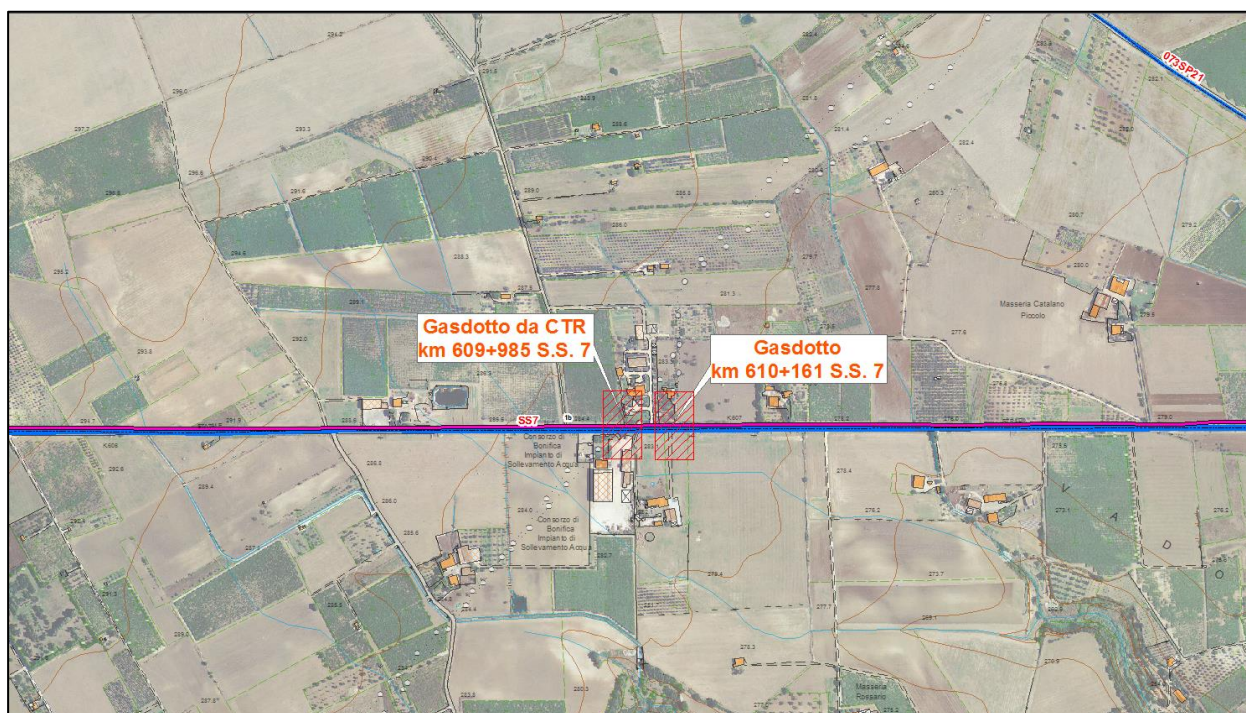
Stralcio planimetrico con individuazione della condotta di progetto interferente con la i gasdotti
